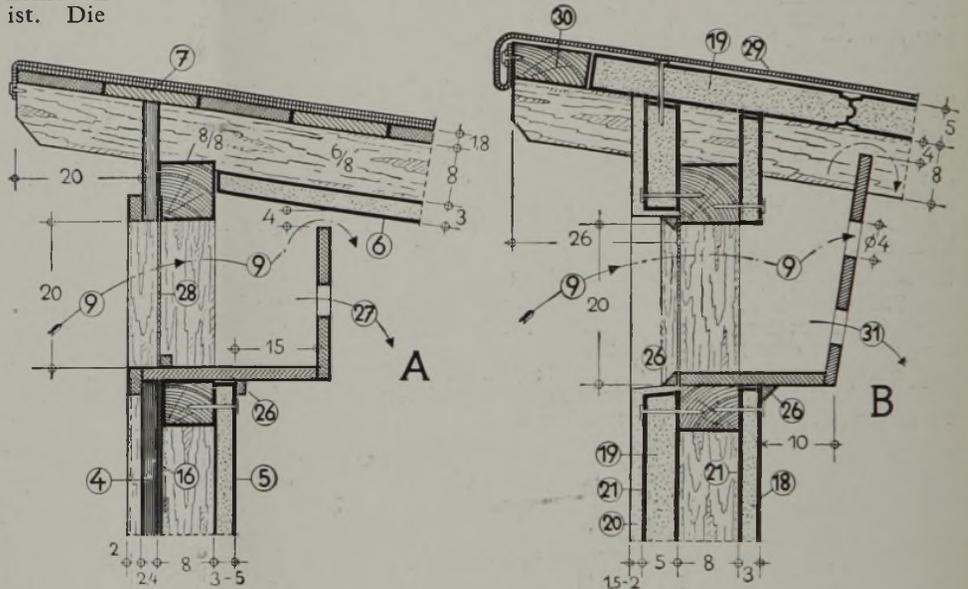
und 8. Lüftungsdetails Vorderfront. Wandausführung A Dach mit Brettern verschalt, B Dach mit Gipsdielen verschalt.
